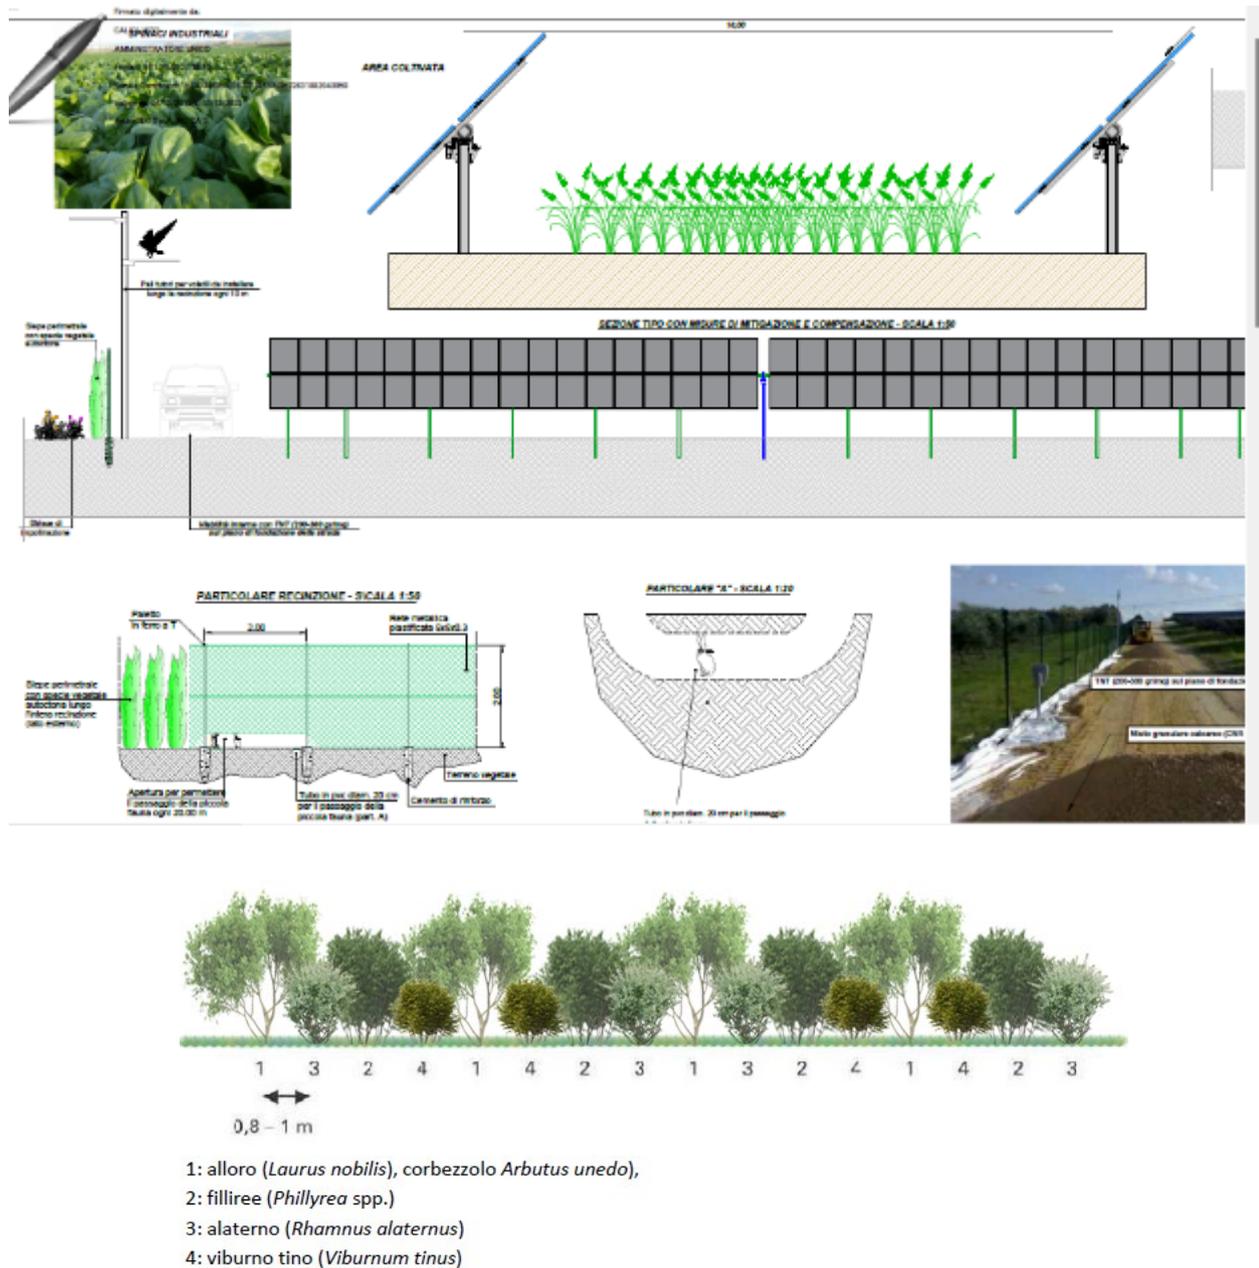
Sezione di impianto, recinzione ed opere di mitigazione
